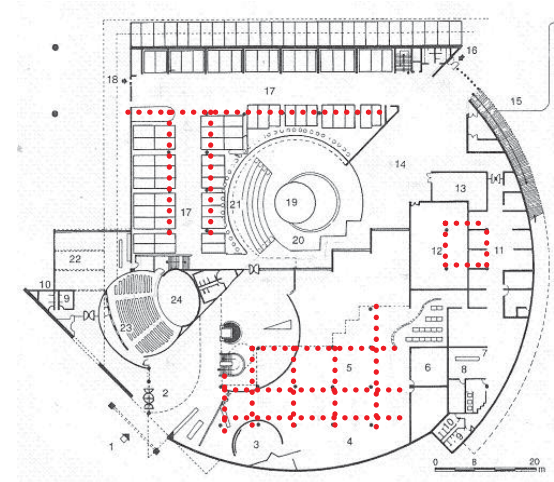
Planta baja, se muestra la distribución de columnas redondas alineadas en sentido longitudinal y transversal formando retículas en los espacios que conforma el edificio.
